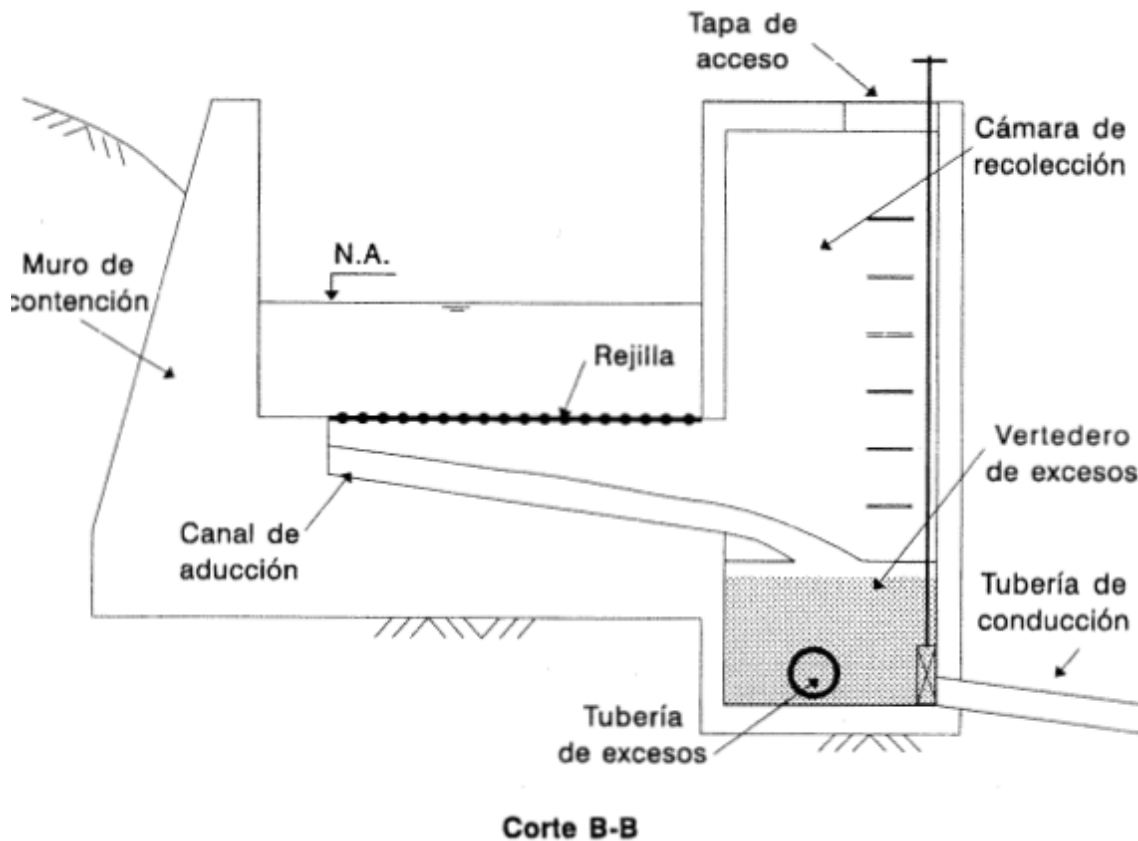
Bocatoma de fondo (corte transversal). Fuente: (Cualla, 2000)
